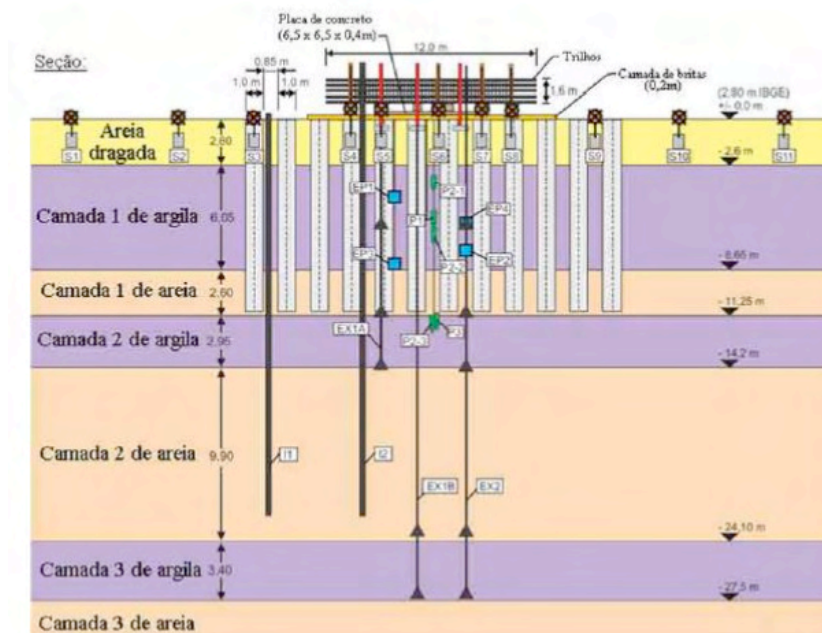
Perfil do terreno adotado após a instalação do aterro de conquista e das colunas de brita com as posições dos equipamentos de instrumentação instalados (Lima, 2012).
